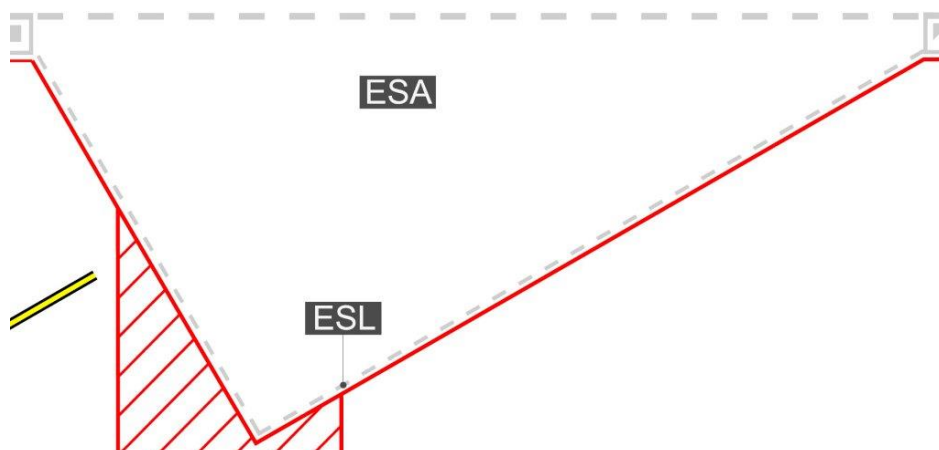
Stralcio della segnaletica dell'area di attesa per il servizio Mezzi di Rampa
